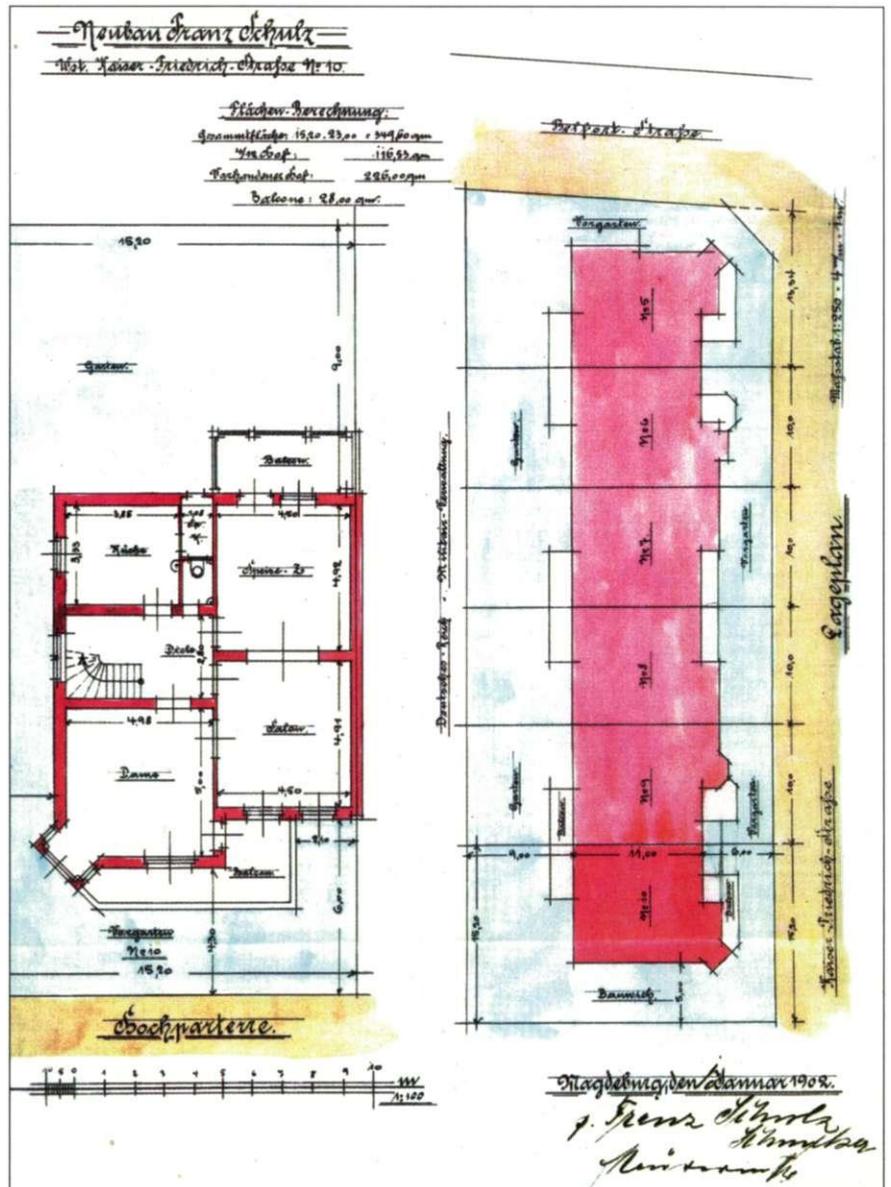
Lageplan Gerhart-Hauptmann-Straße 46 a - 56 und Grundriß des Hochparterres Gerhart-Hauptmann-Straße 56
